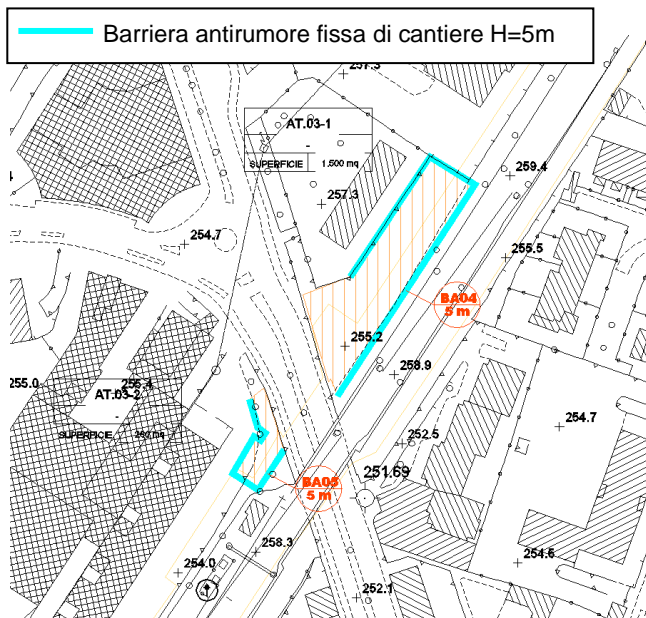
Localizzazione delle barriere antirumore di cantiere BA04 e BA05
